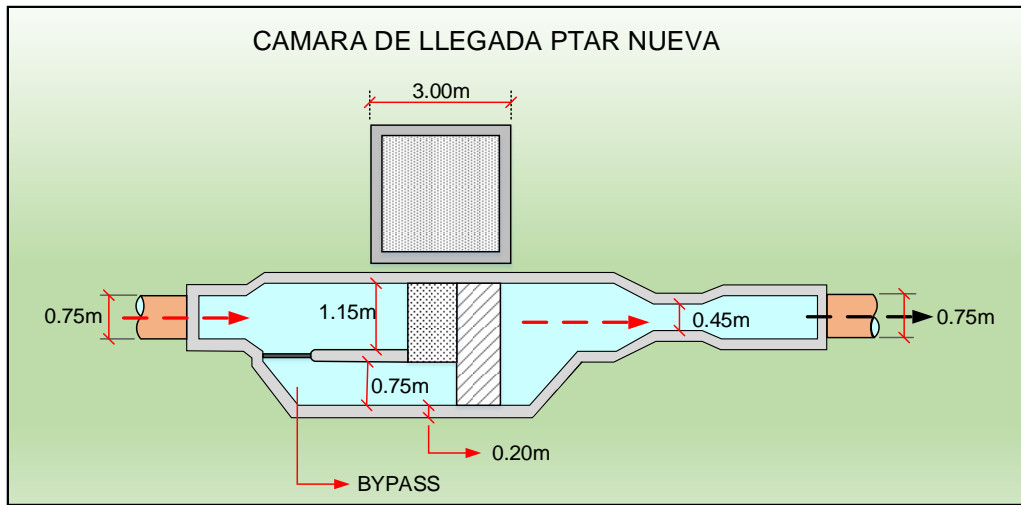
Vista en Planta de Canal de aproximación de Laguna Anaerobia Nueva.
